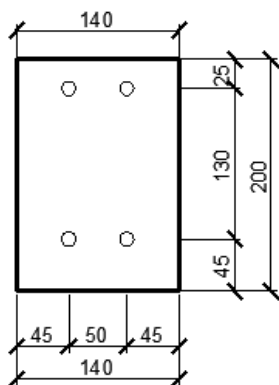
Приведений поперечний переріз при нагріванні з боку розтягнутої арматури
